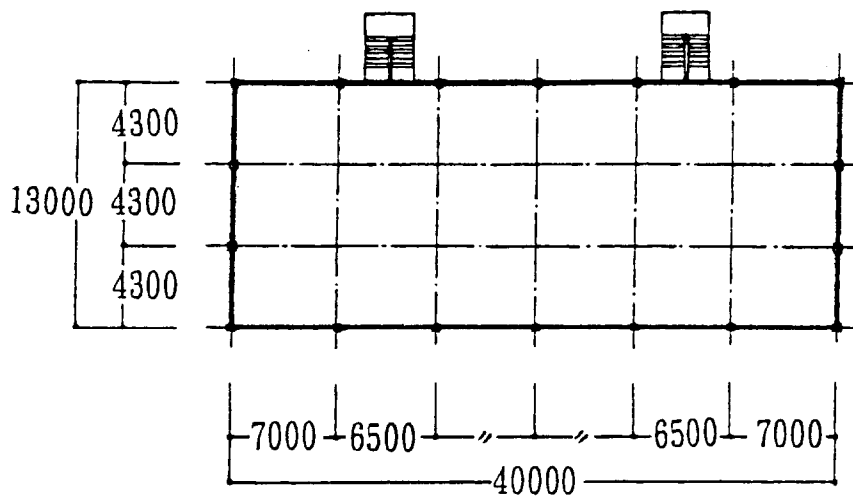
場所打ちP R C ボイドスラブ集合住宅平面図
